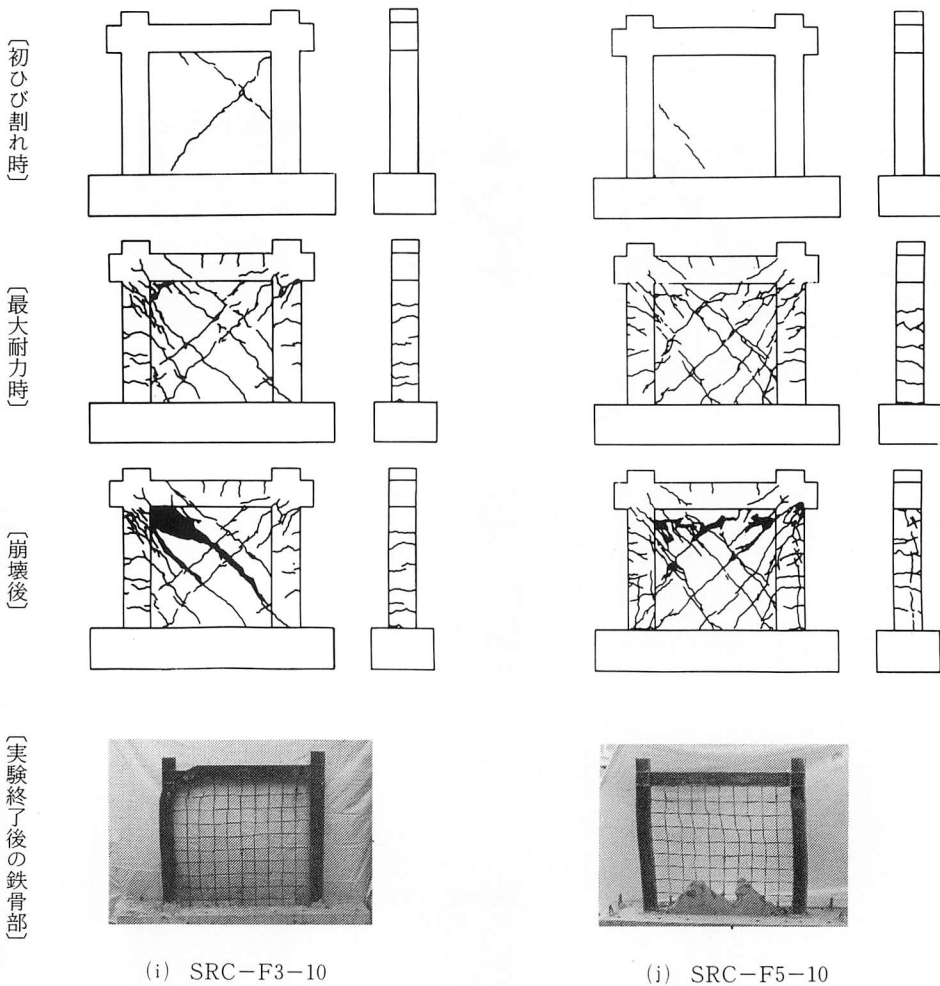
ひび割れ性状, および実験終了後の鉄骨部 (その3)
